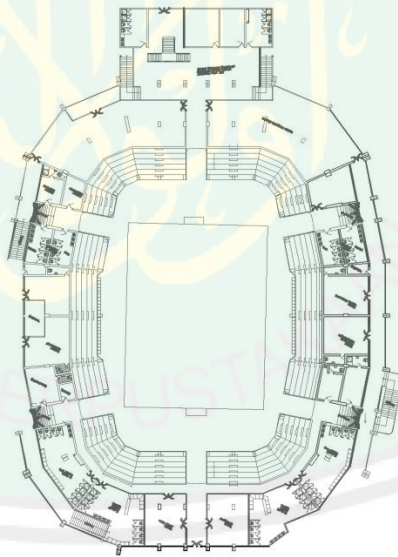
Denah lantai 2 Stadion Voli Pantai
